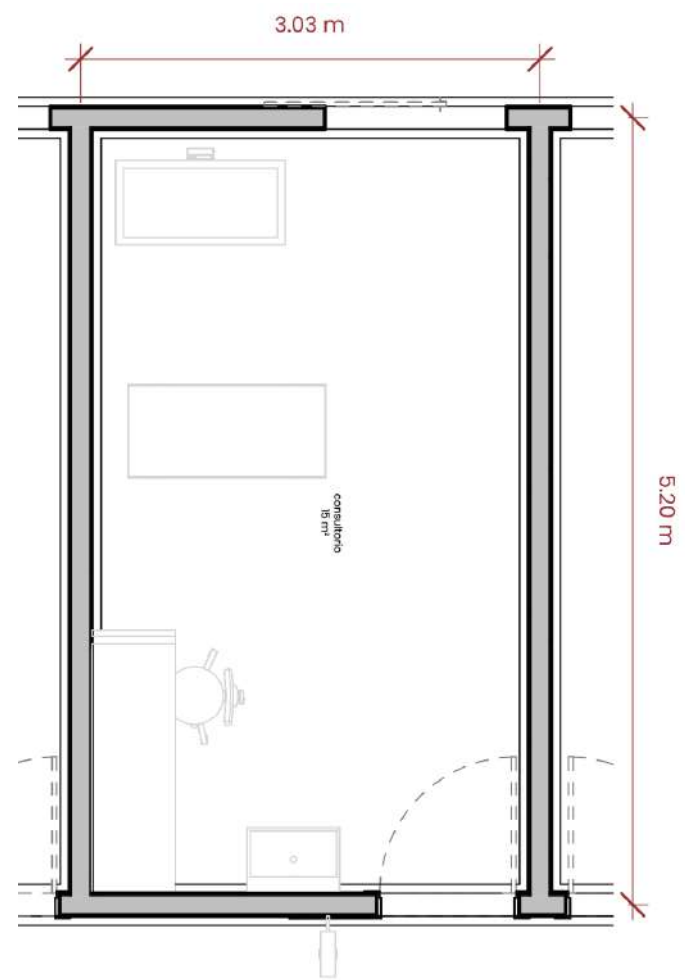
Detalle consultorio para perros. Fuente: Elaboración propia
